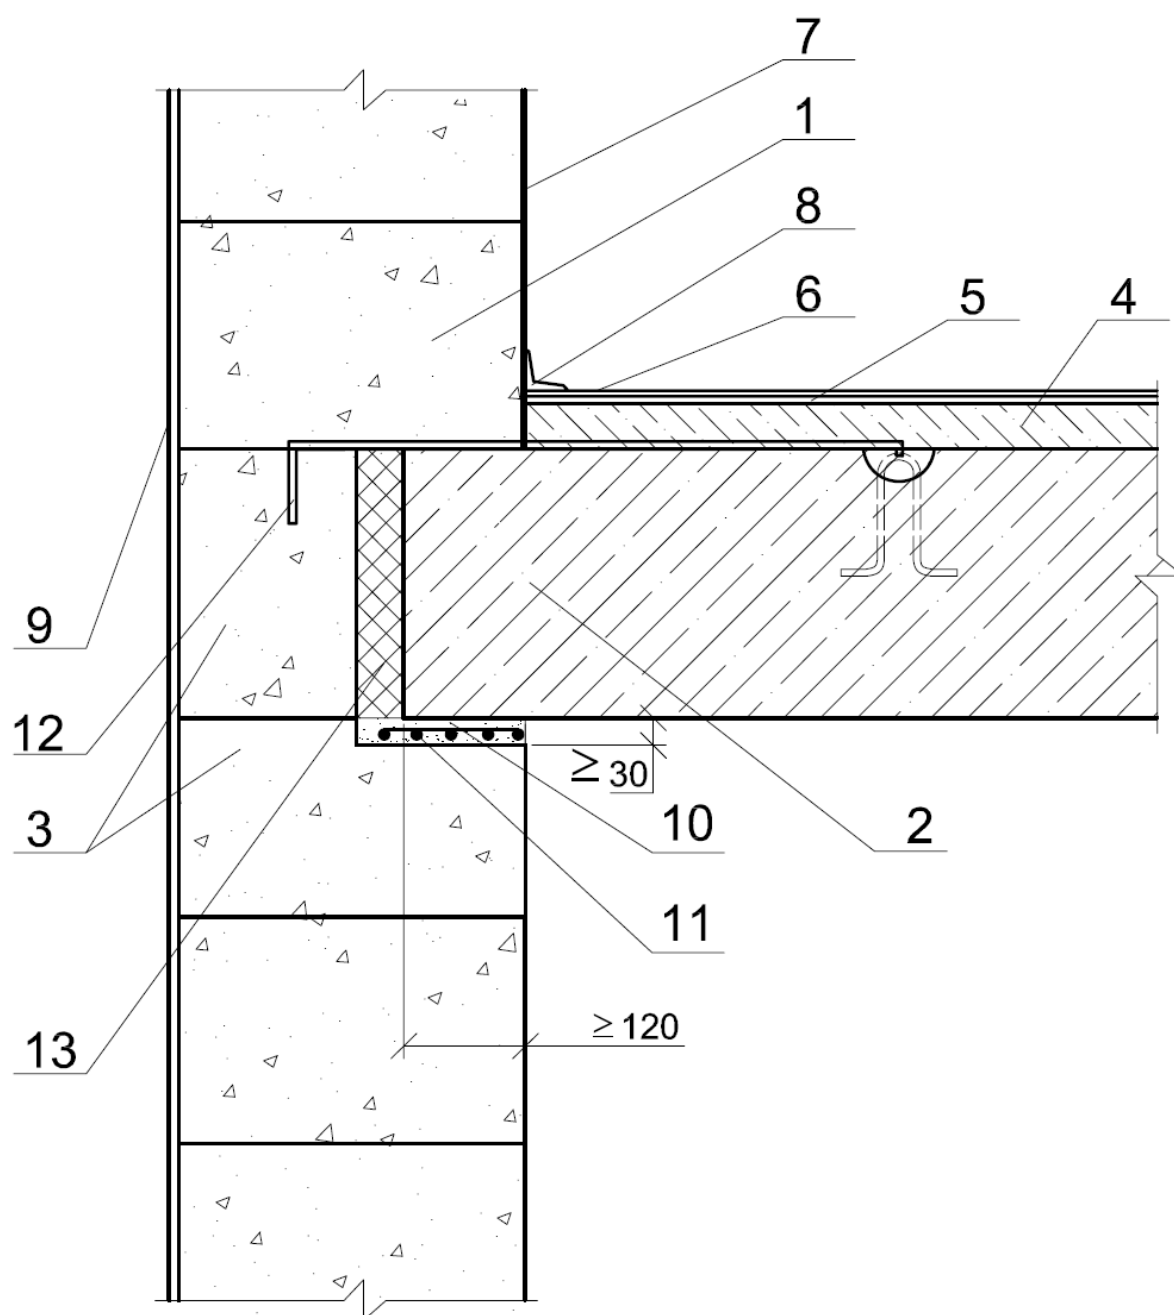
Опирание железобетонных сборных плит перекрытия на наружную несущую стену из газобетонных блоков по ряду кирпичей
